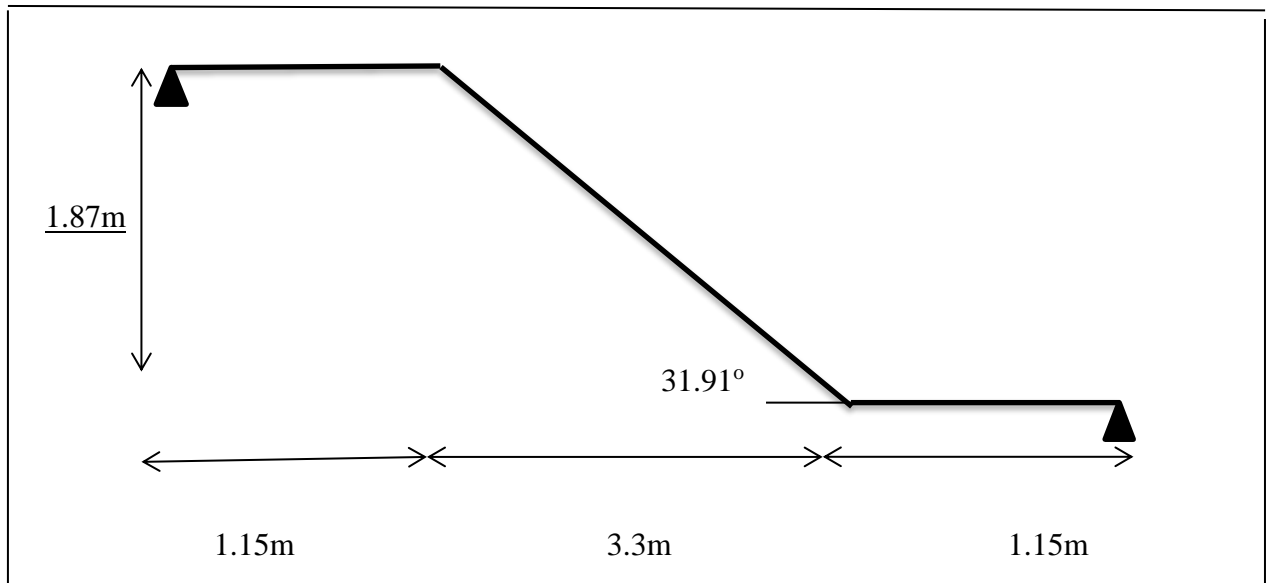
section schéma de ferrailage de l'escalier type étage courant
